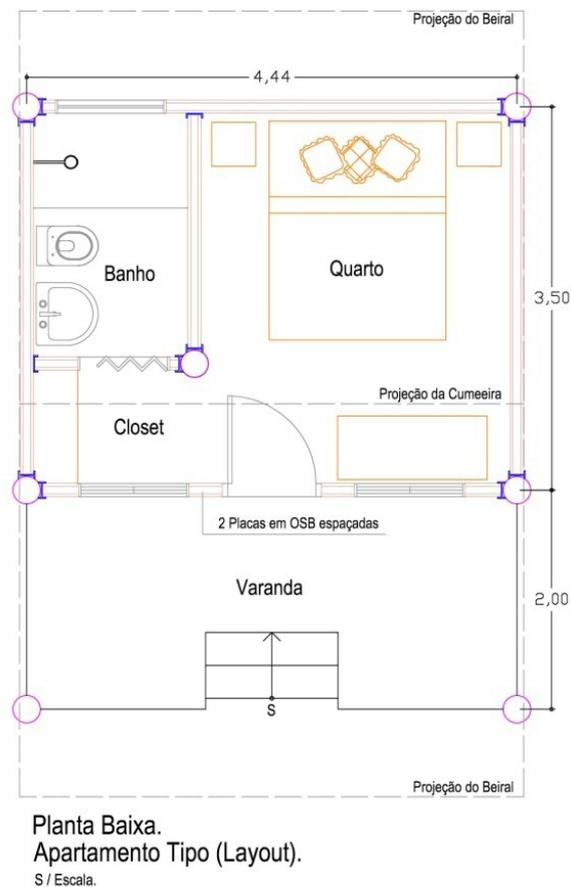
Planta layout em estrutura de toras de eucalipto tratado.
